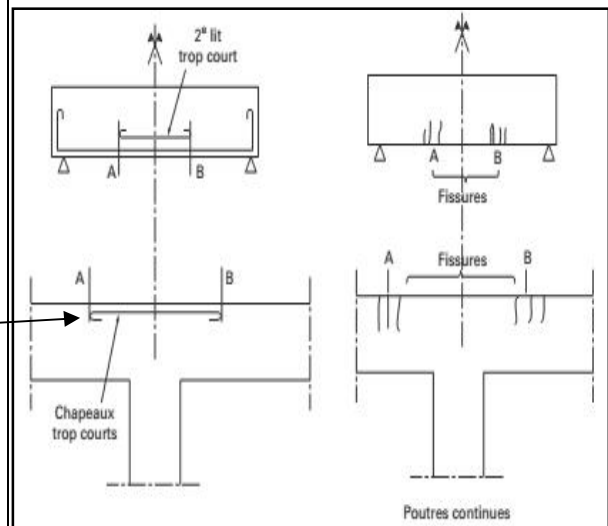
(b) : Manque de ferrailage au niveau de joint du plancher et semelles.
